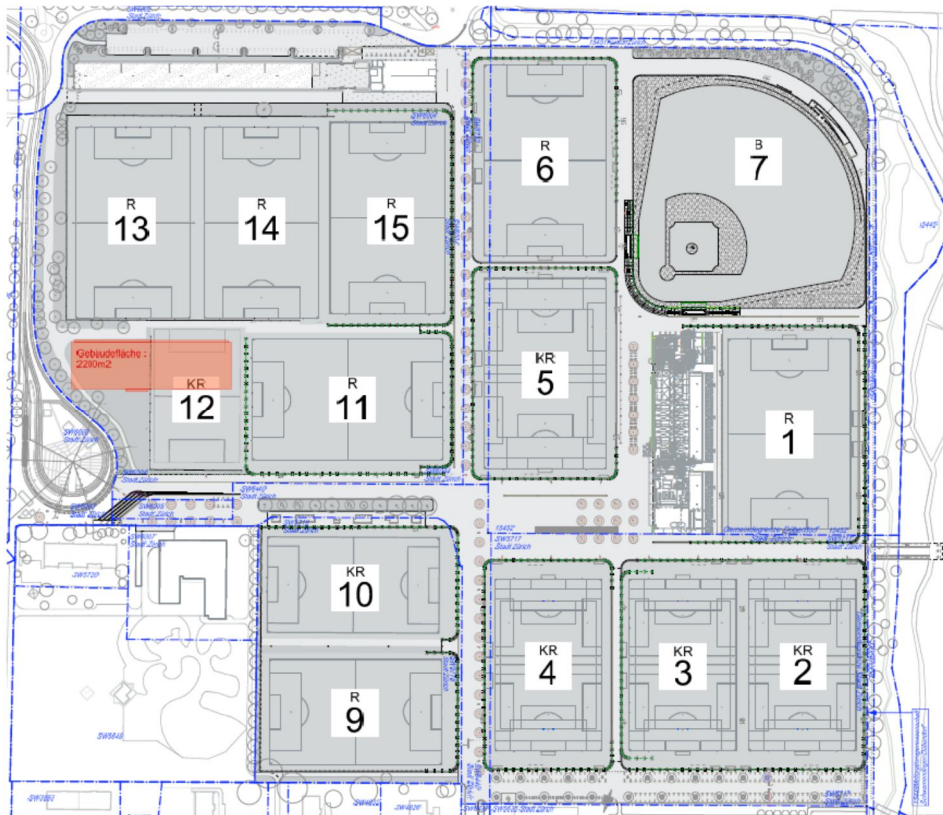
Sportanlage Heerenschürli mit Baurechtsfläche («Gebäudefläche»)
